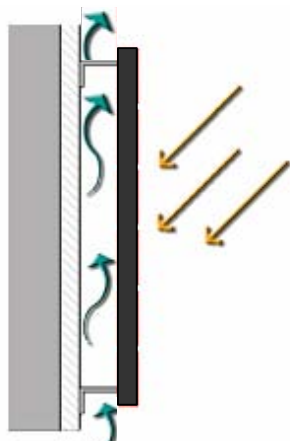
Fachada ventilada. (Imagen del autor)
